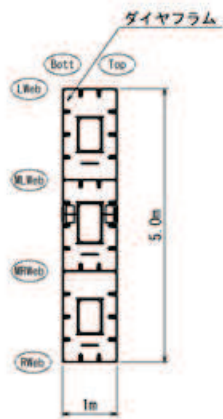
(2) 鋼製遮水壁 (鋼桁 2) 平面図
